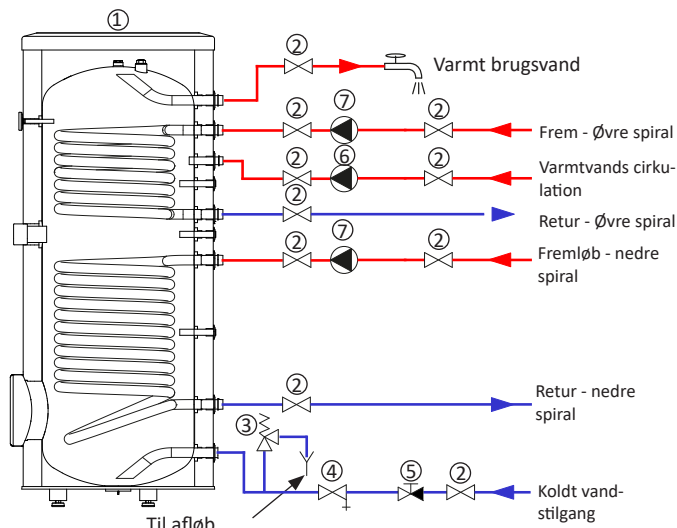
Installationsskema for beholder med 2 spiraler BA-ST
